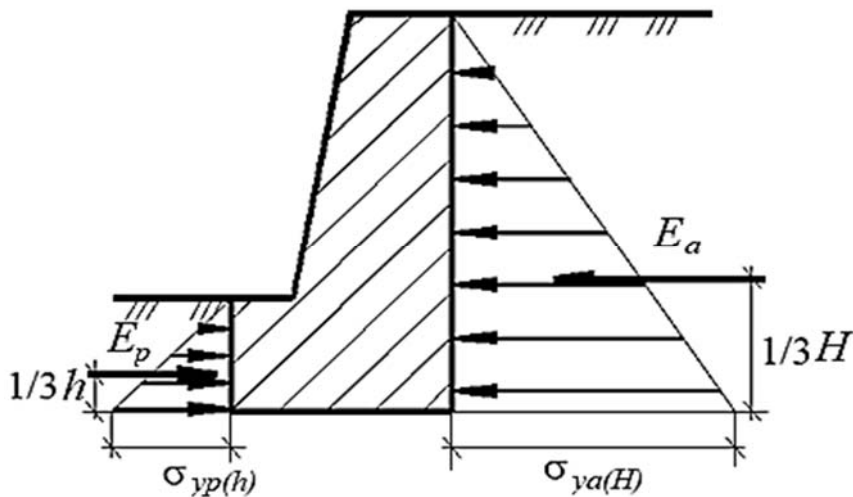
Расчетная схема подпорной стены при определении давления от идеально сыпучего грунта
